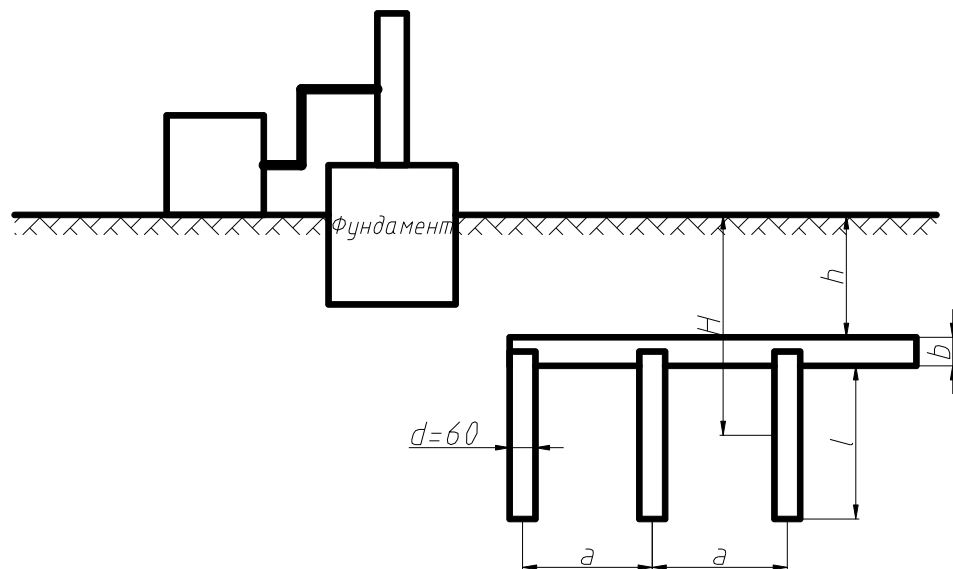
Розрахункова схема заземлення верстату:
